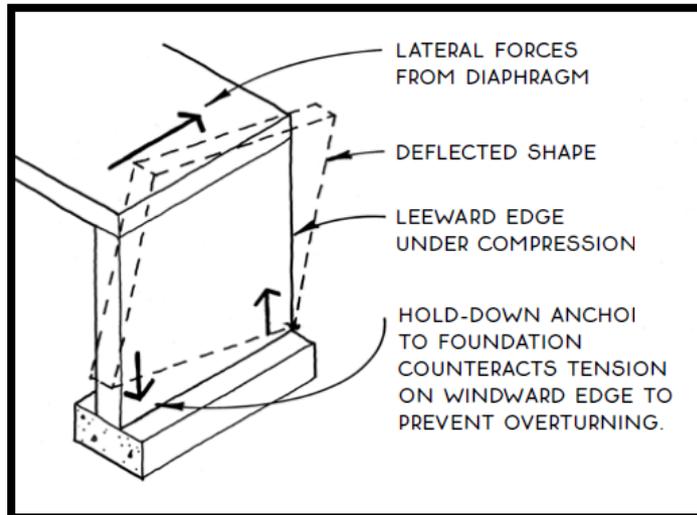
Shearwall. Fuente: Fuente: Frame Construction - RobThallon.
